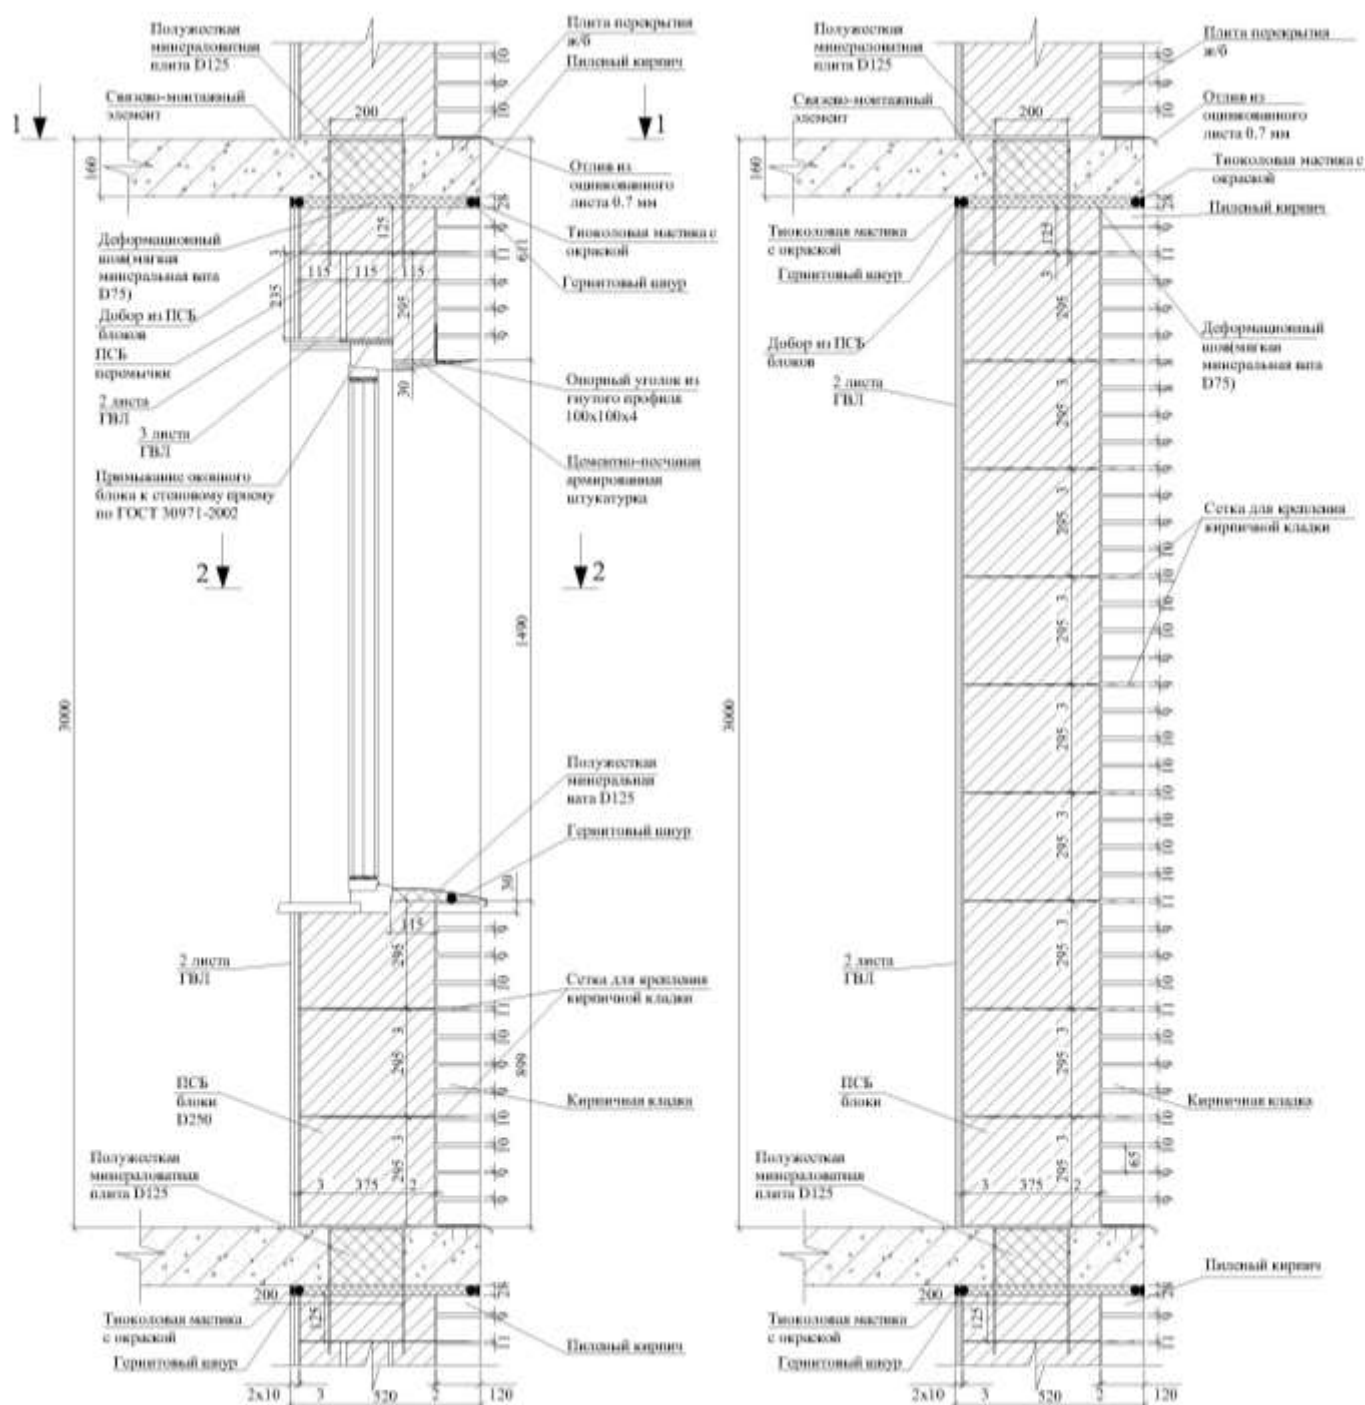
Несущая стена из ПСБ блоков с наружной облицовкой толщиной 120 мм и внутренне облицовкой ГВЛ. Вертикальные разрезы по оконному проему и глухому простенку
